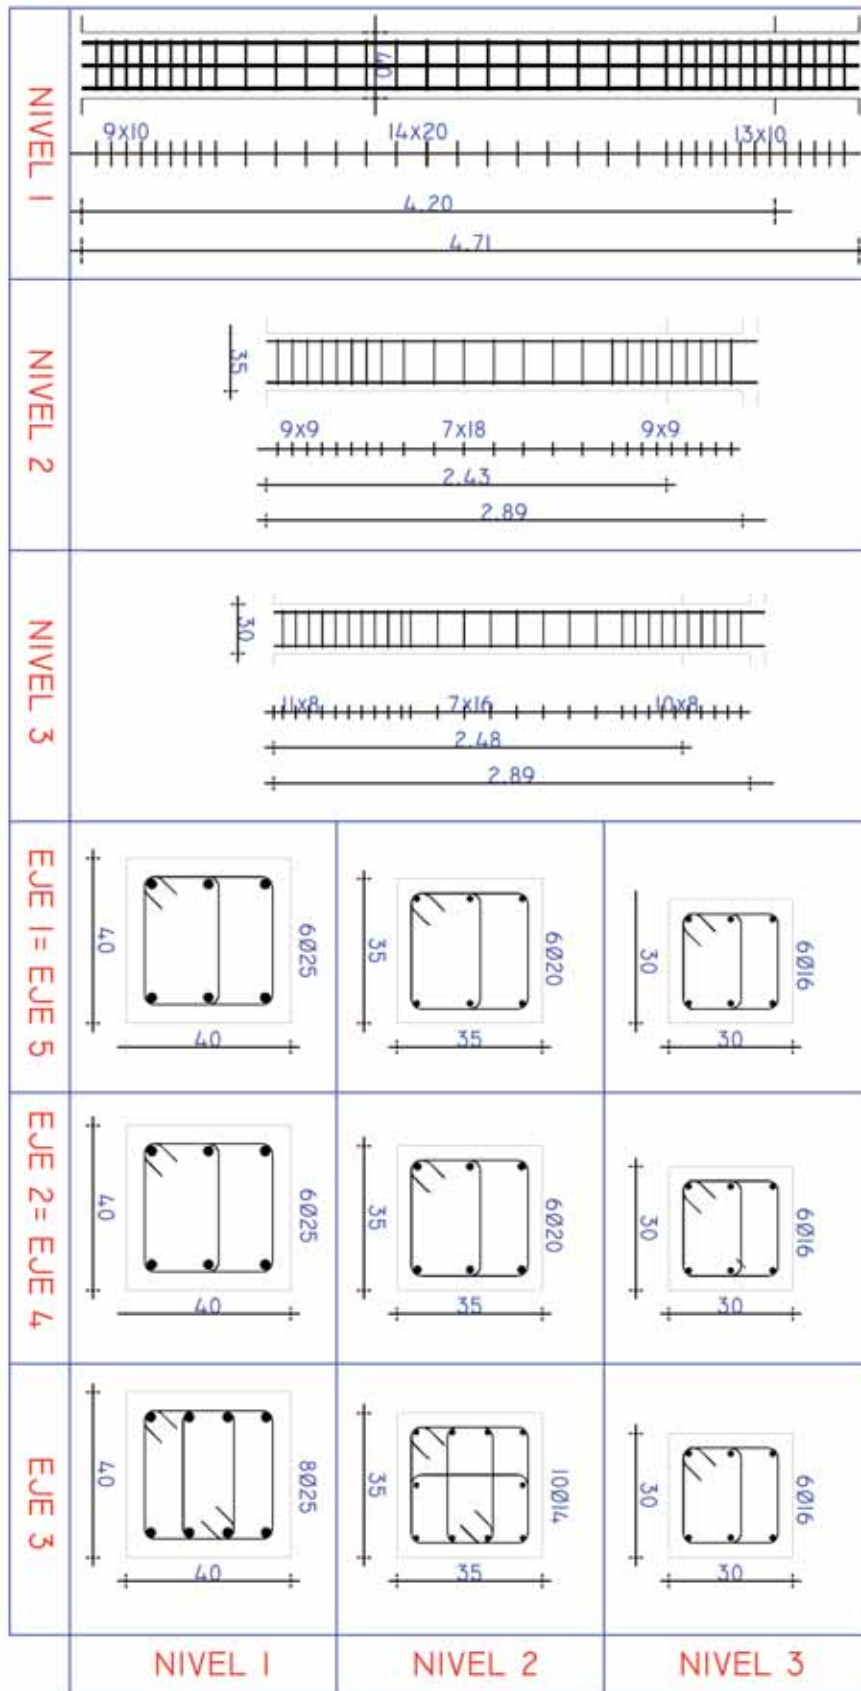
Detalles de armado de los pilares del pórtico exterior.
